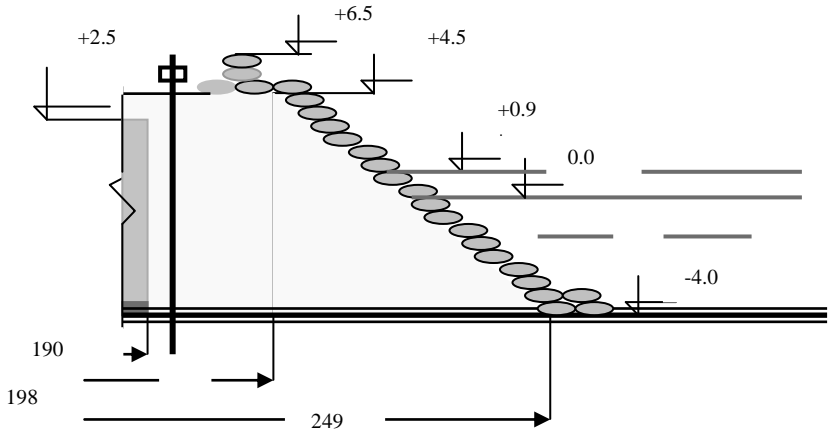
Поперечный разрез ледогрунтового острова (к примеру расчета)
